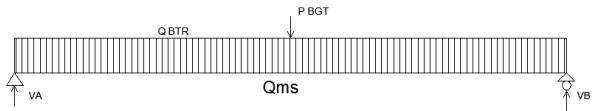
32 Permodelan Beban Mati Girder Tepi Bentang 23 m
